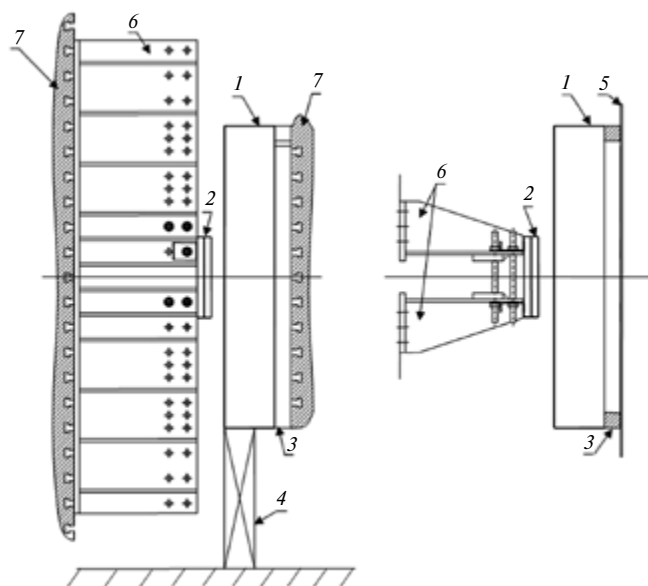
Схема испытаний железобетонных плит на продавливание: 1 – опытный образец; 2 – пуансон; 3 – опорный контур; 4 – опорный столик; 5 – опорная плита; 6 – опорный элемент; 7 – плита прессы
